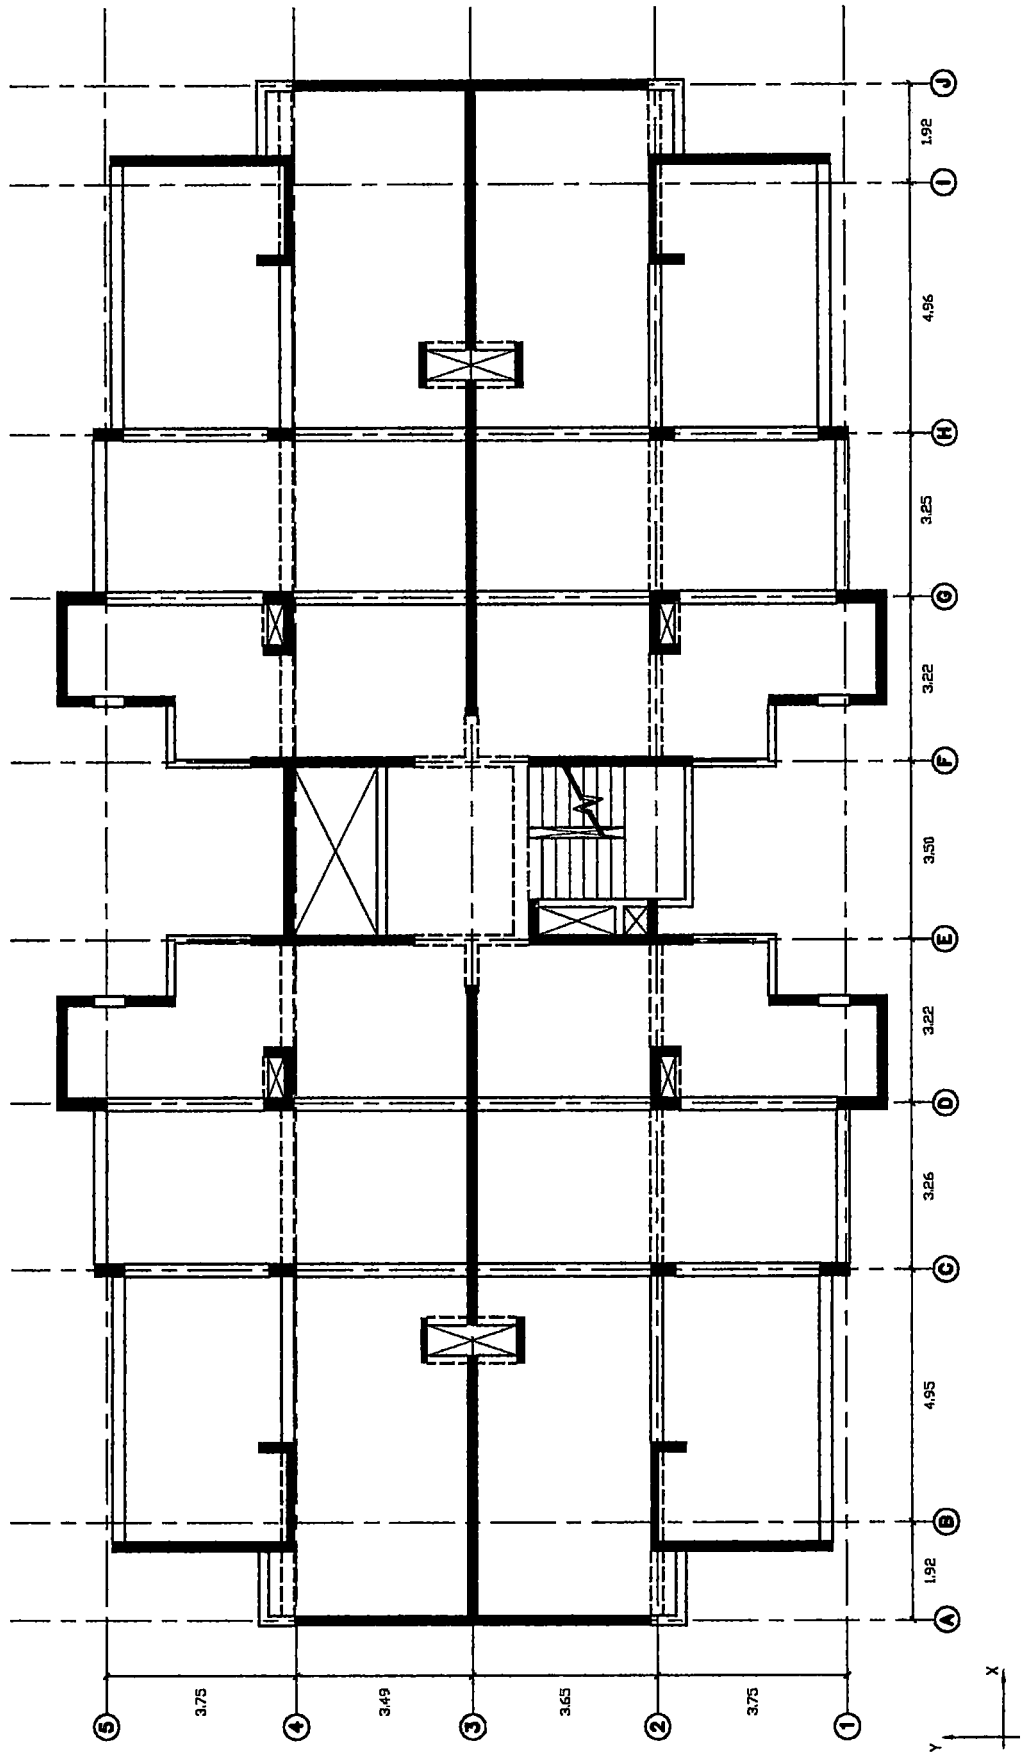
EDIFICIO DE 12 PISOS - PLANTA TÍPICA
